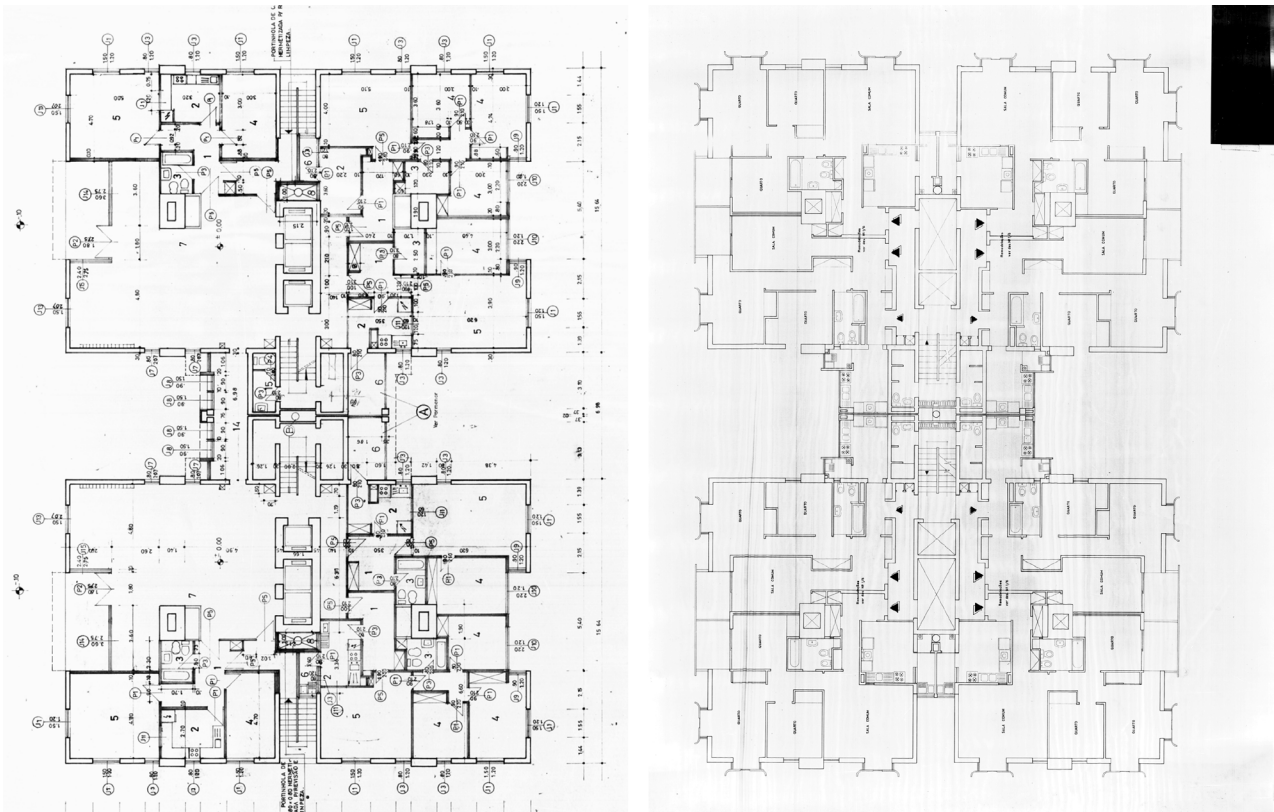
Proyecto de alteraciones. Planta baja y planta tipo de los pisos 1 a 13. En planta baja aparecen apartamentos de una y tres habitaciones y, en los demás pisos, la vivienda “tipo A” se transforma en dos apartamentos (“T2” y “T3”). Proyecta.
